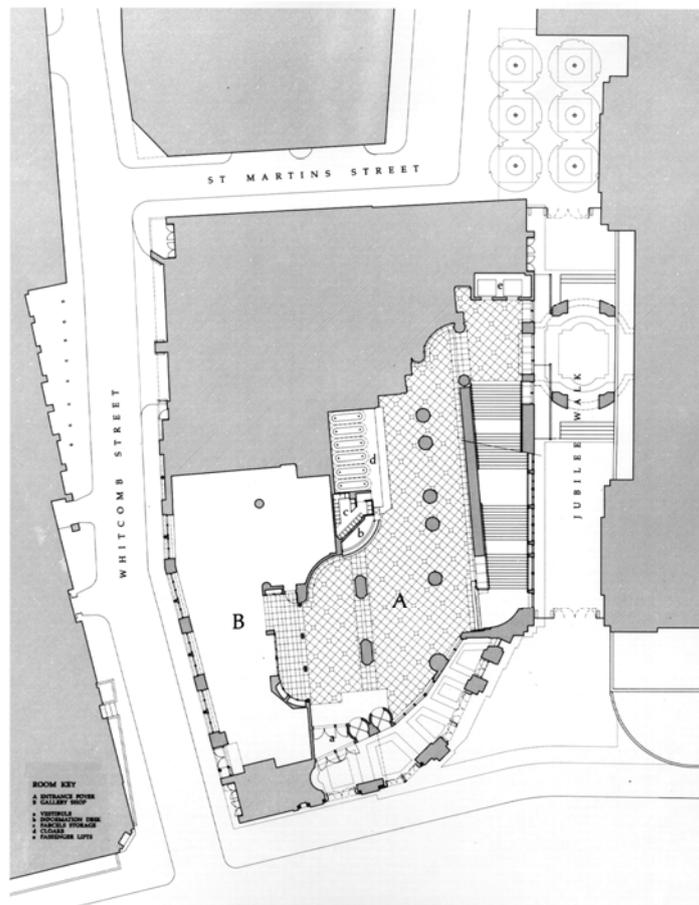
Planta do pavimento térreo, mostrando apenas as áreas de público.
